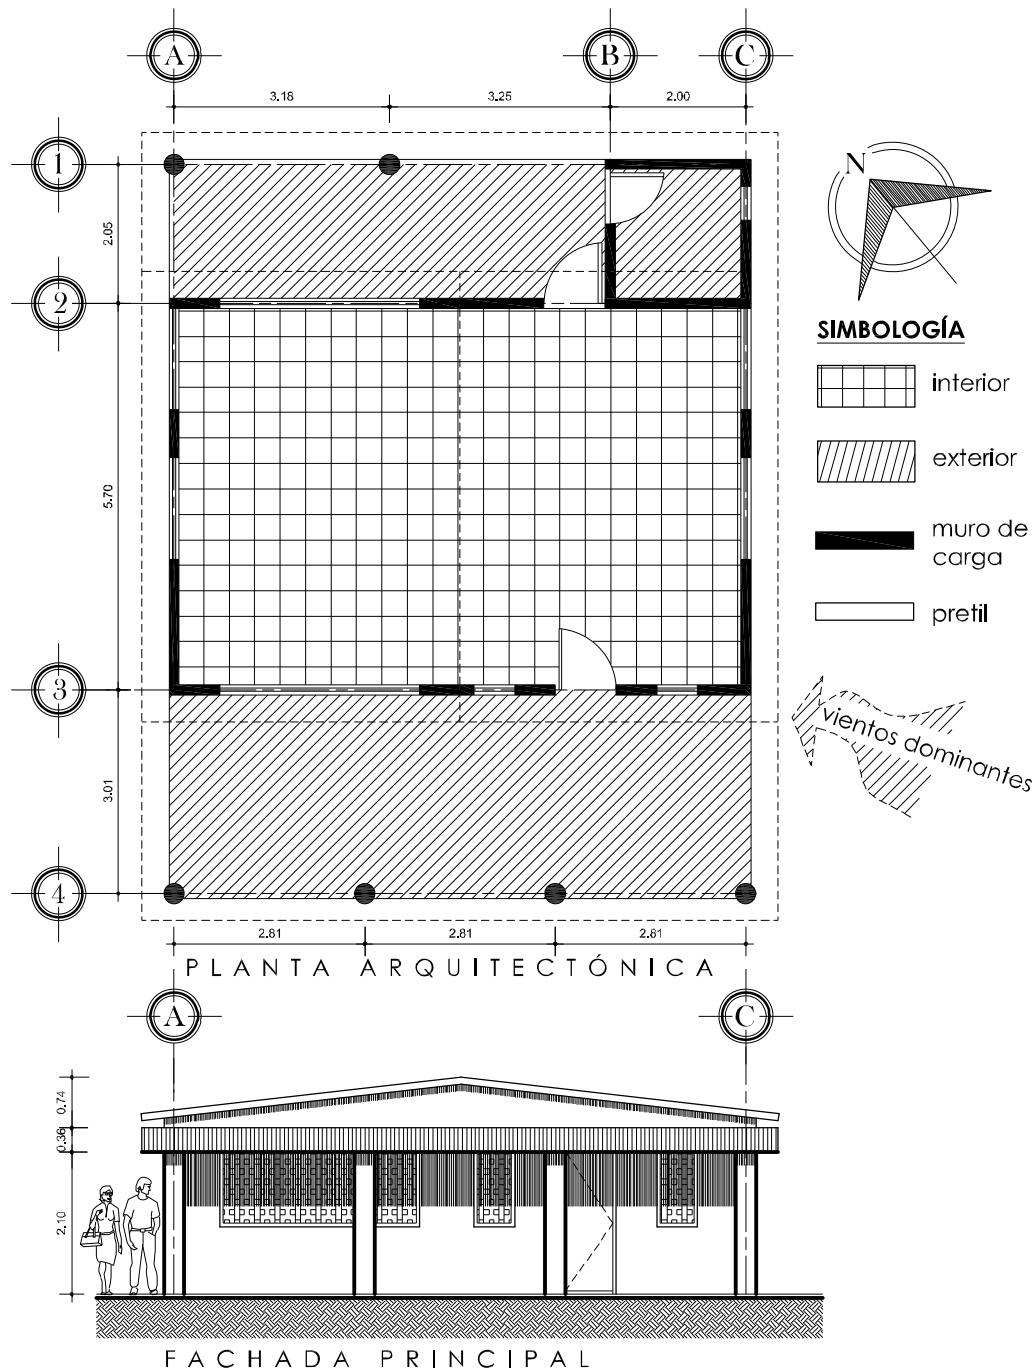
VIVIENDA 3 FUENTE: Levantamiento realizado por Alejandro Ocampo Arcos.
